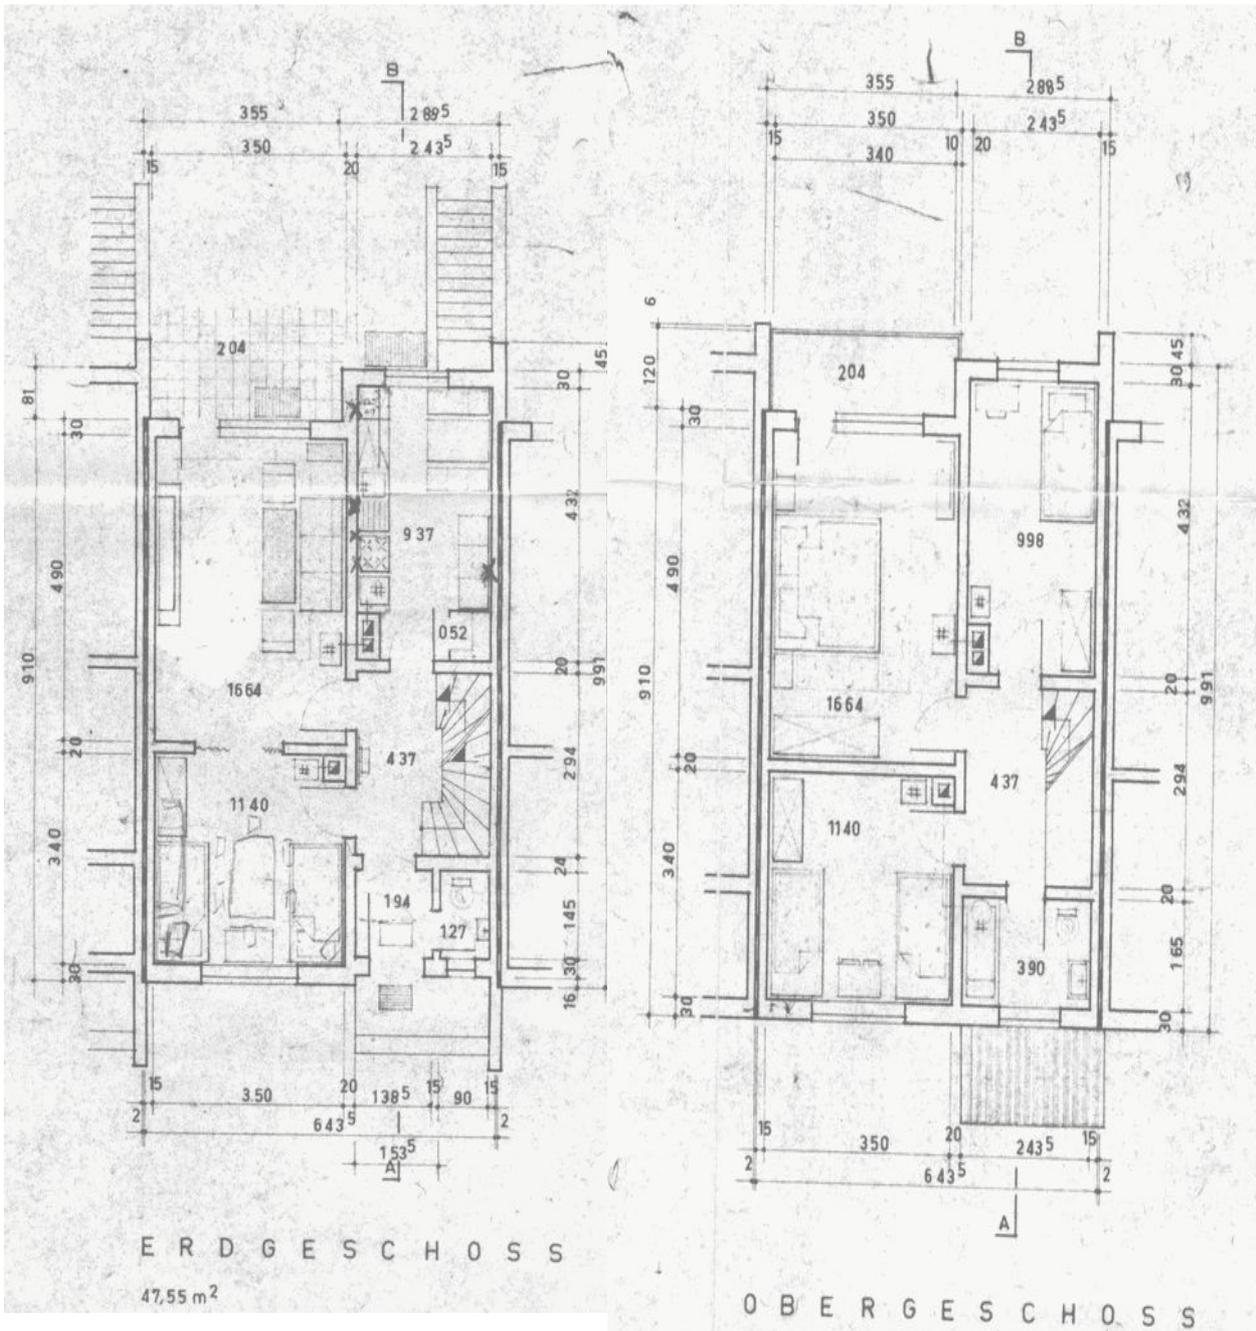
Grundrissplan des Reihenhaus Typ IV
